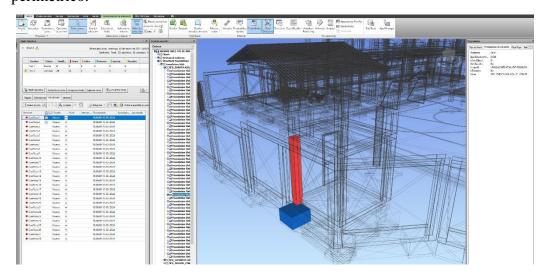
Interferencia entre Columna y Zapata del Tanque elevado interfieren con cimentación del cerco perimétrico.
